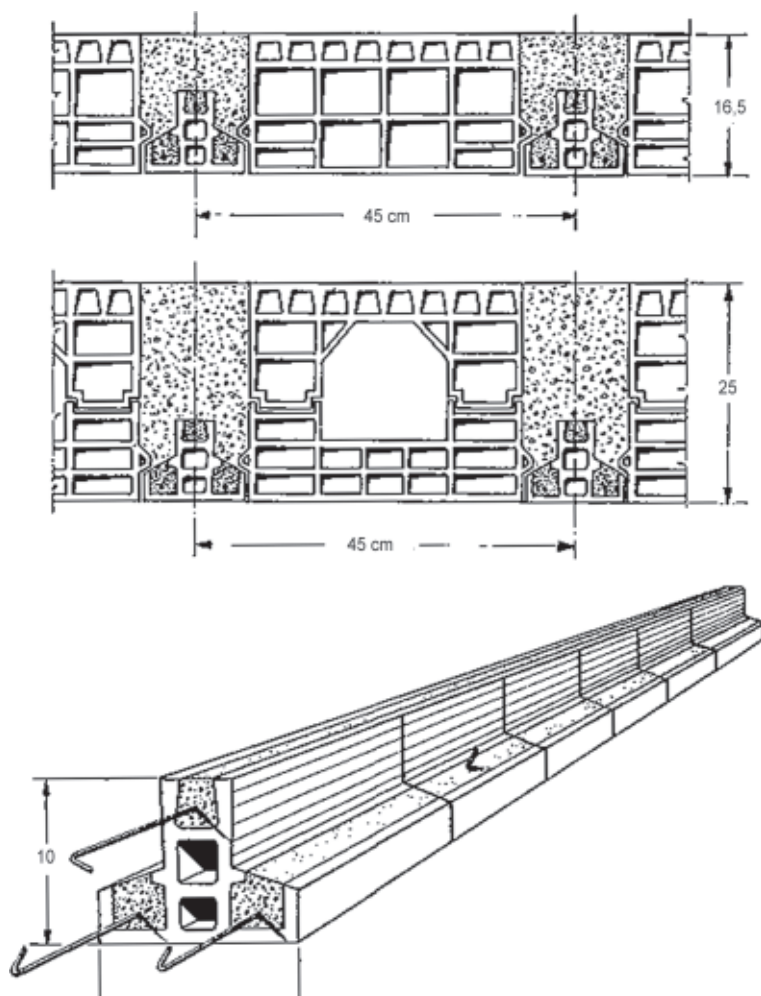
Solaio con travetti prefabbricati in c.a. e laterizio. Il vantaggio di questo solaio è quello di ottenere un intradosso piano in laterizio atto a ridurre i fenomeni di elettroforesi. Come già scritto per il solaio senza soletta il cls non è stato più ammesso dalle norme a partire dal 1972
